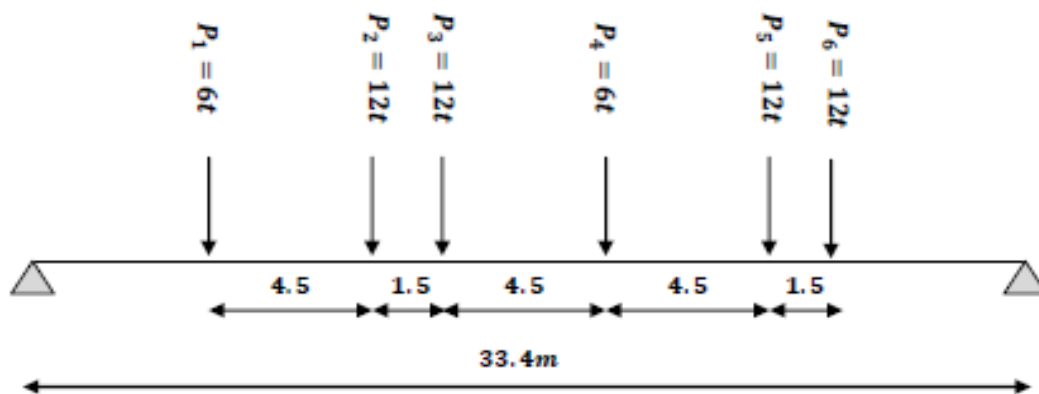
système B_c disposition de deux camions sur la chaussée (sens longitudinal)
